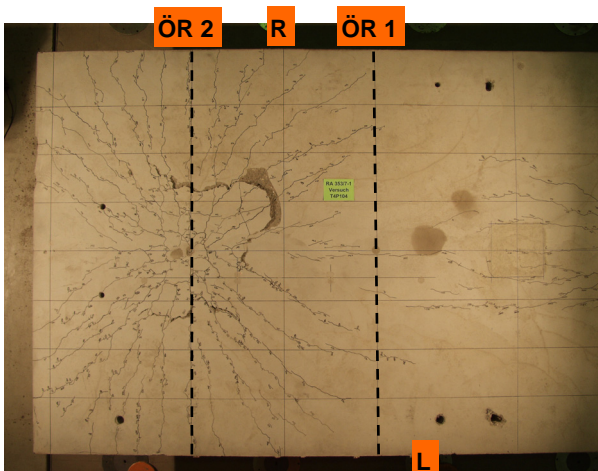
Rissbild auf der Betongurtoberseite
